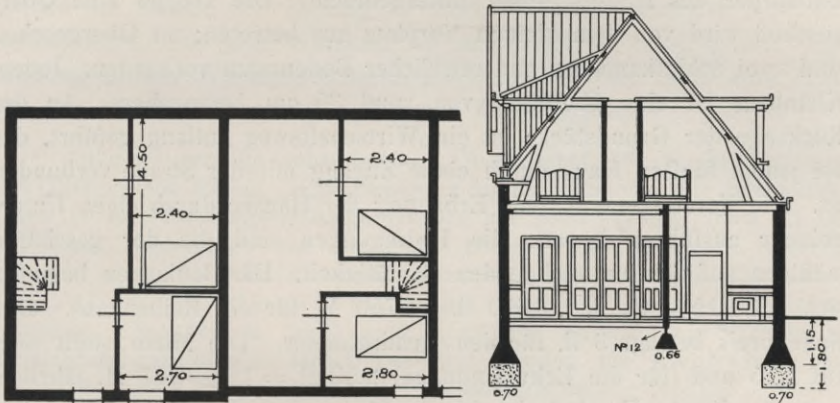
Grundriß zu Abb. 82. Obergeschoß.
